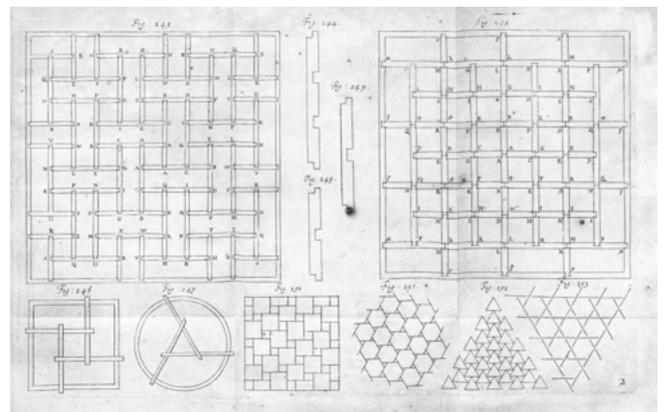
Manera de construir un suelo plano por medio de vigas unidas entre sí más cortas que el lado de la superficie a cubrir (Wallis, 1670).
